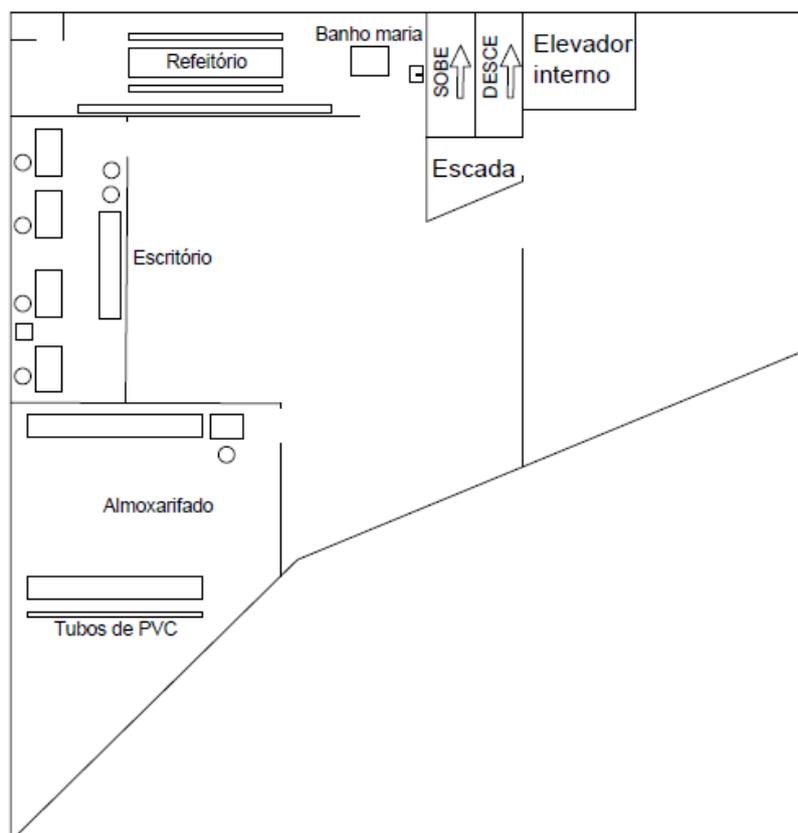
Croqui do canteiro de obras no primeiro pavimento. Fonte: Elaborado pelo autor.
